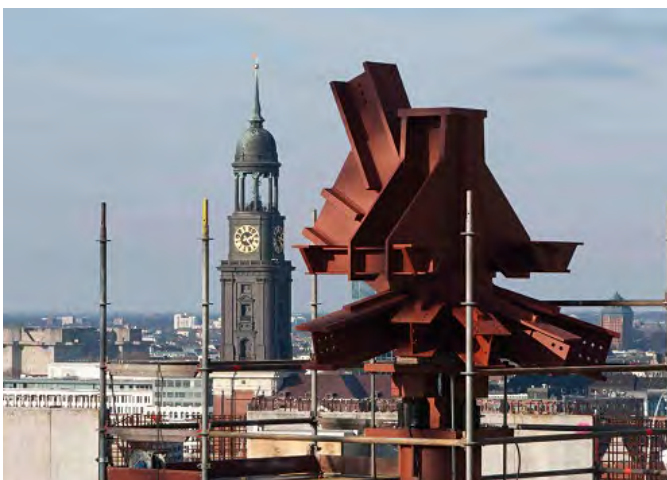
Knotenpunkt für die Untergurte der Ostfachwerke
